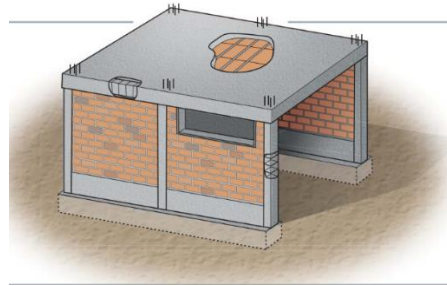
Albañilería confinada (Aceros Arequipa, 2005).
